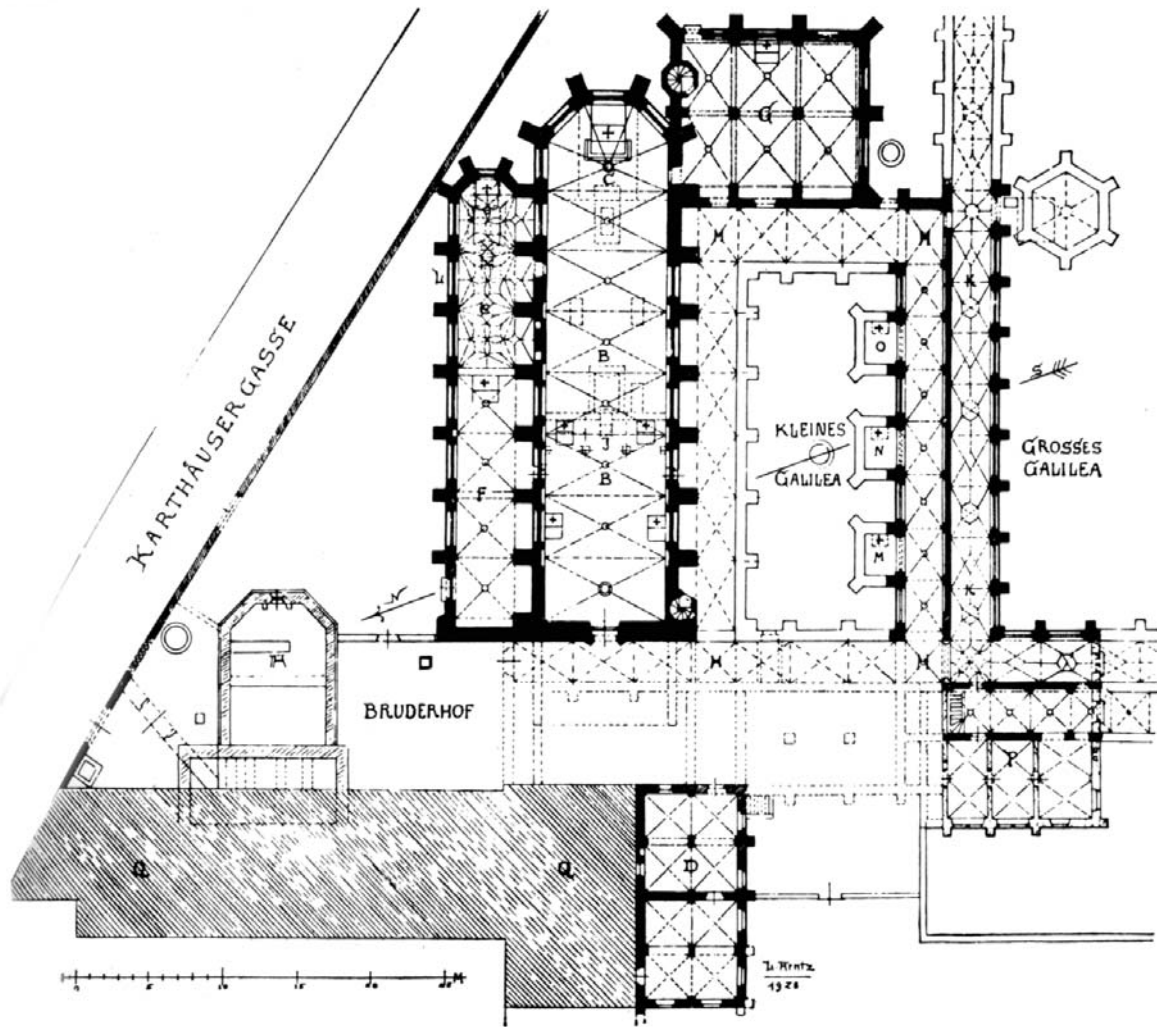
Ludwig Arntz – Grundriss der Kölner Kartause St. Barbara
